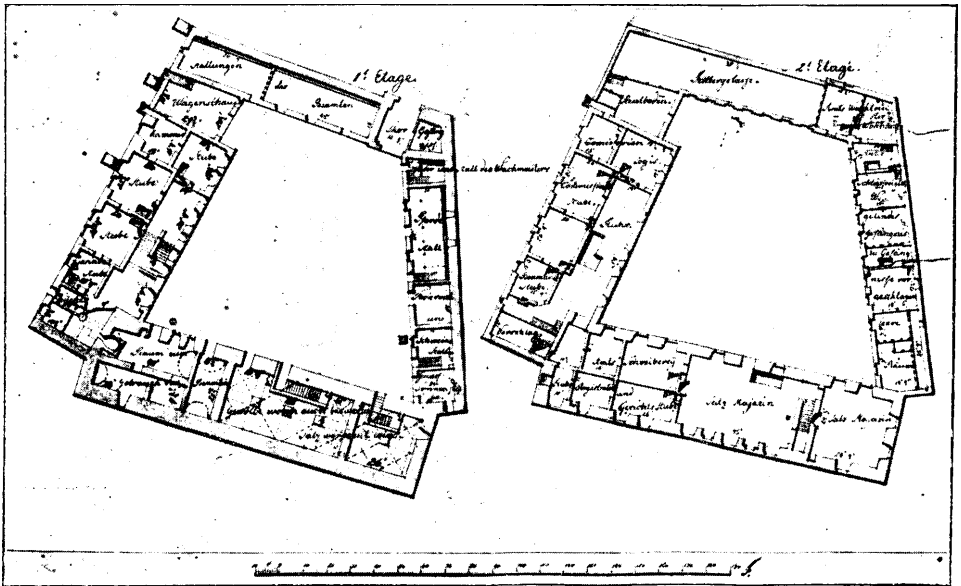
Burg Mehlsack, Grundrisse des Erd- und Hauptgeschosses.
